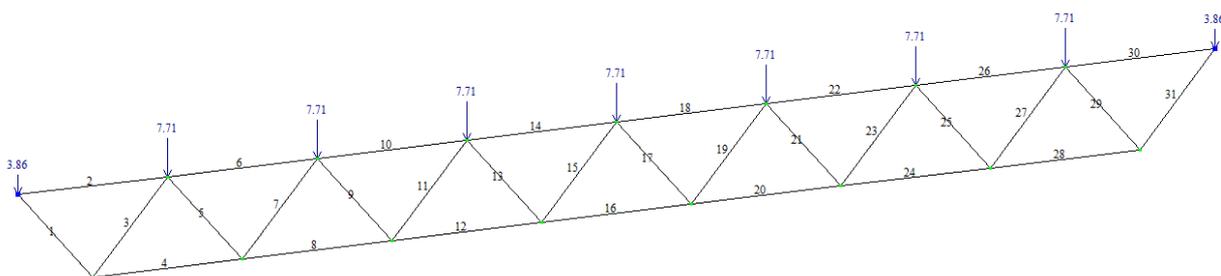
Загрузка 2, нагрузка от покрытия кровли
